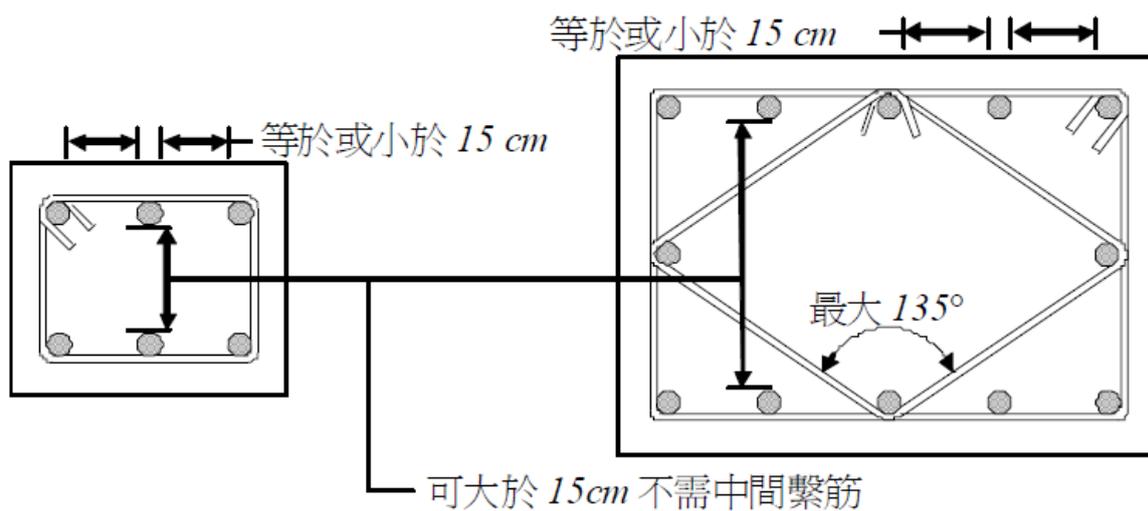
現行混凝土結構設計規範 RC 柱(梁)橫向鋼筋配置圖
